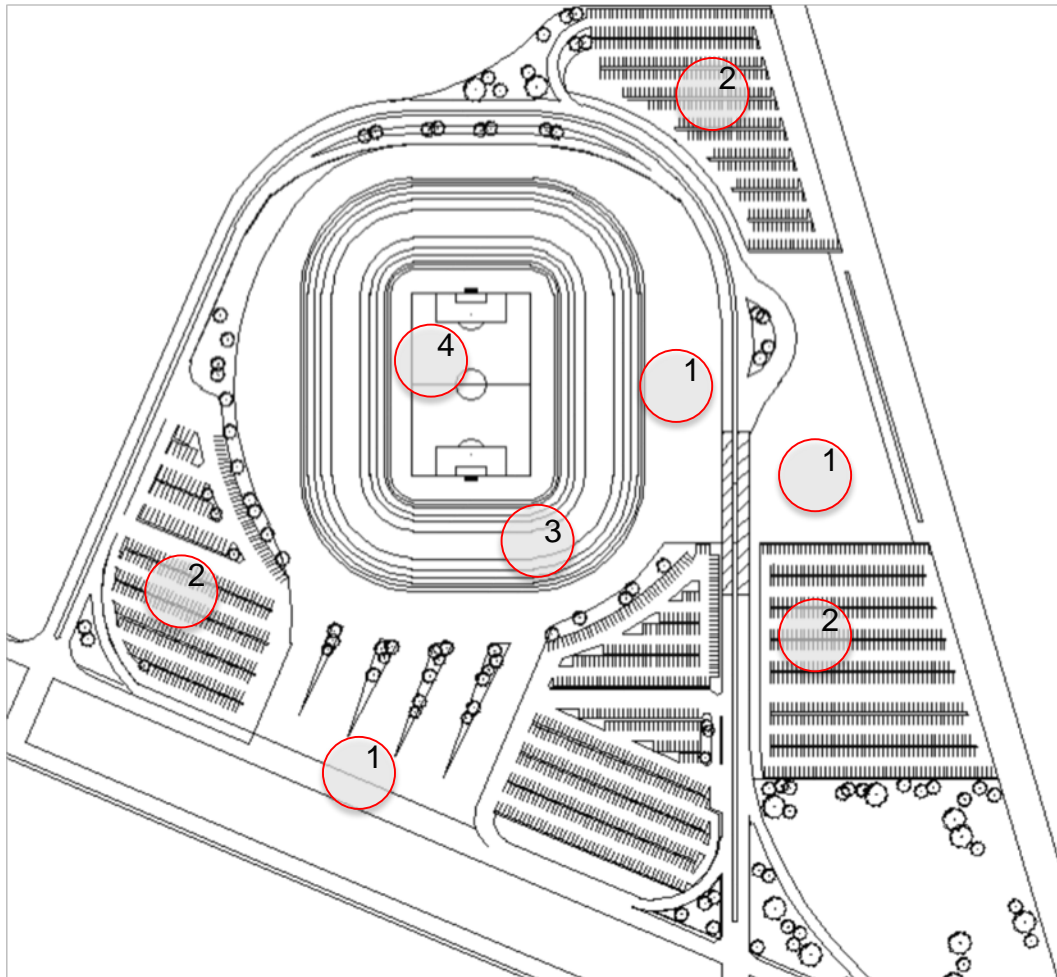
Partido Arquitectónico: Planta de conjunto, sin escala.
